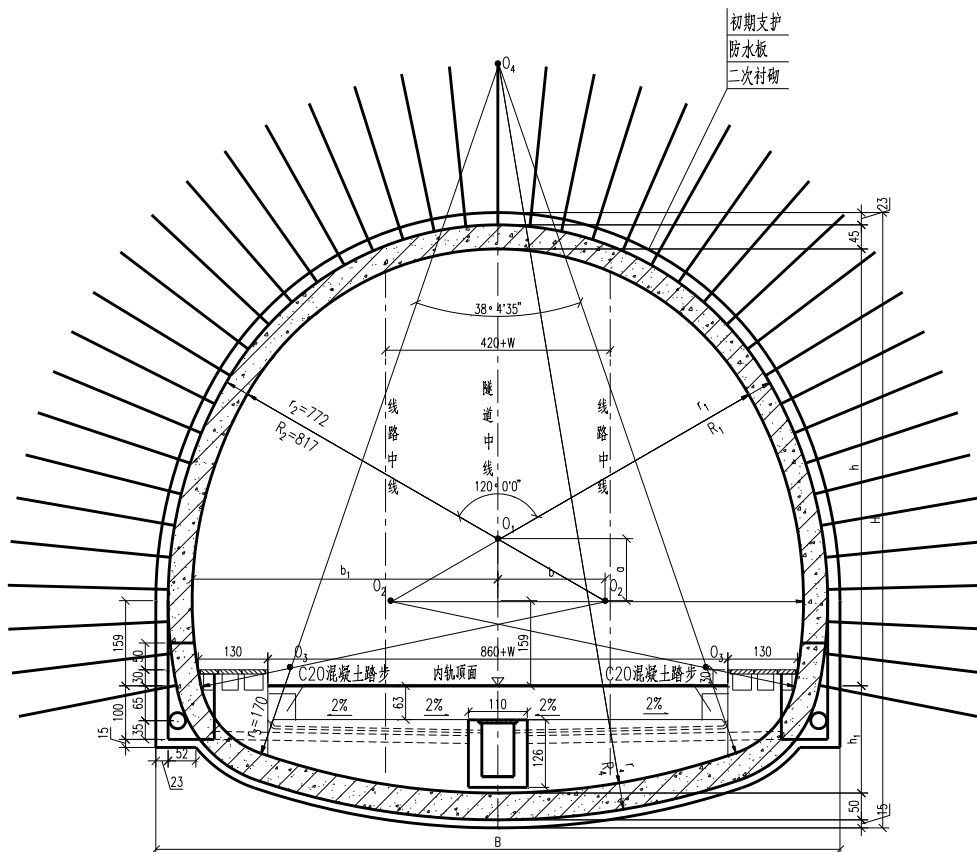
160km/h 单洞双线矿山法隧道衬砌断面图 (IVb 型复合式衬砌断面)
